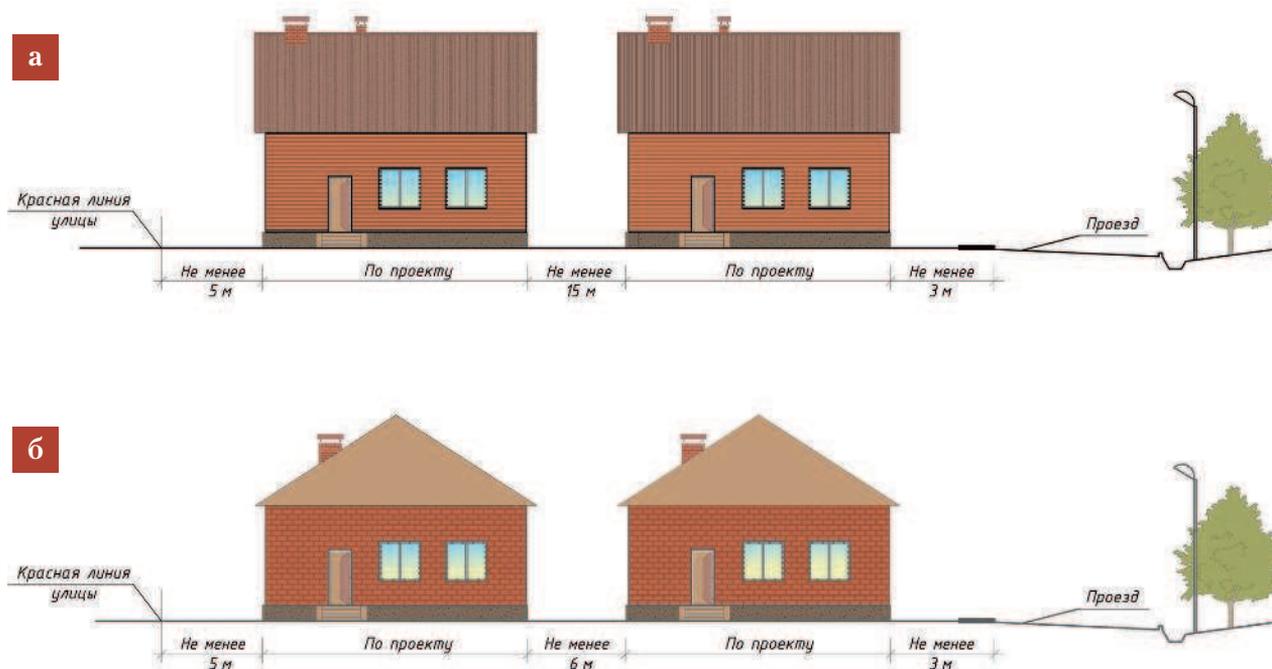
Нормативные расстояния между домами, красными линиями, проездами: *а* — дома с деревянными стенами; *б* — дома с каменными стенами и монолитными перекрытиями
